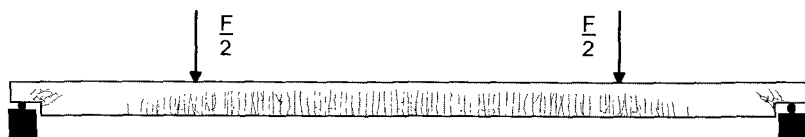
Abgeschlossenes Rissbild von Balken G02 aus Stahlfaserbeton bei Erreichen der Traglast
